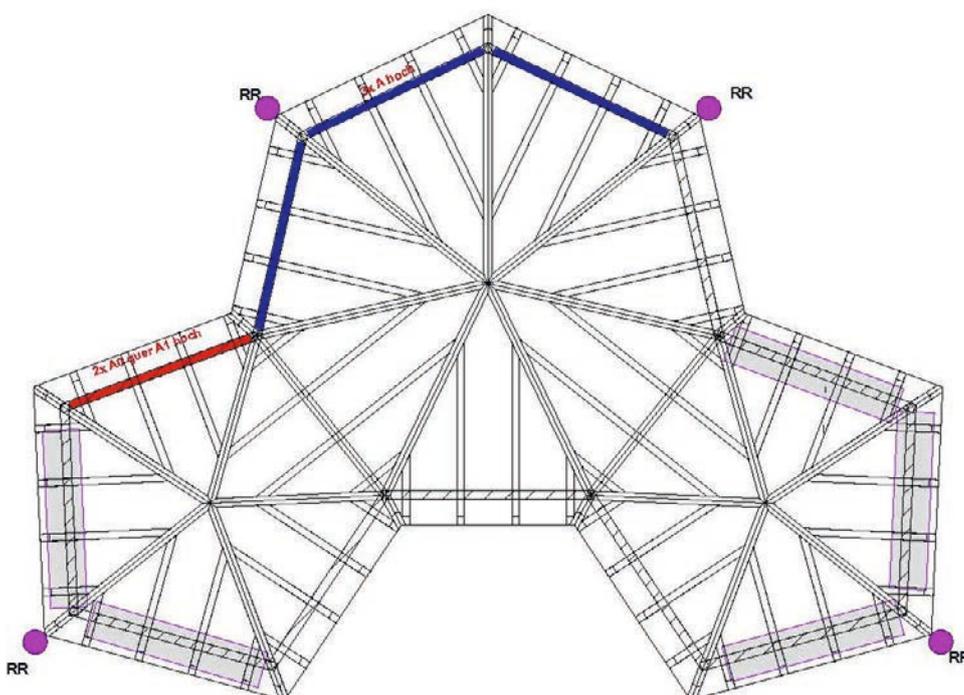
Grundriss des Pavillons Baumkraftwurz
